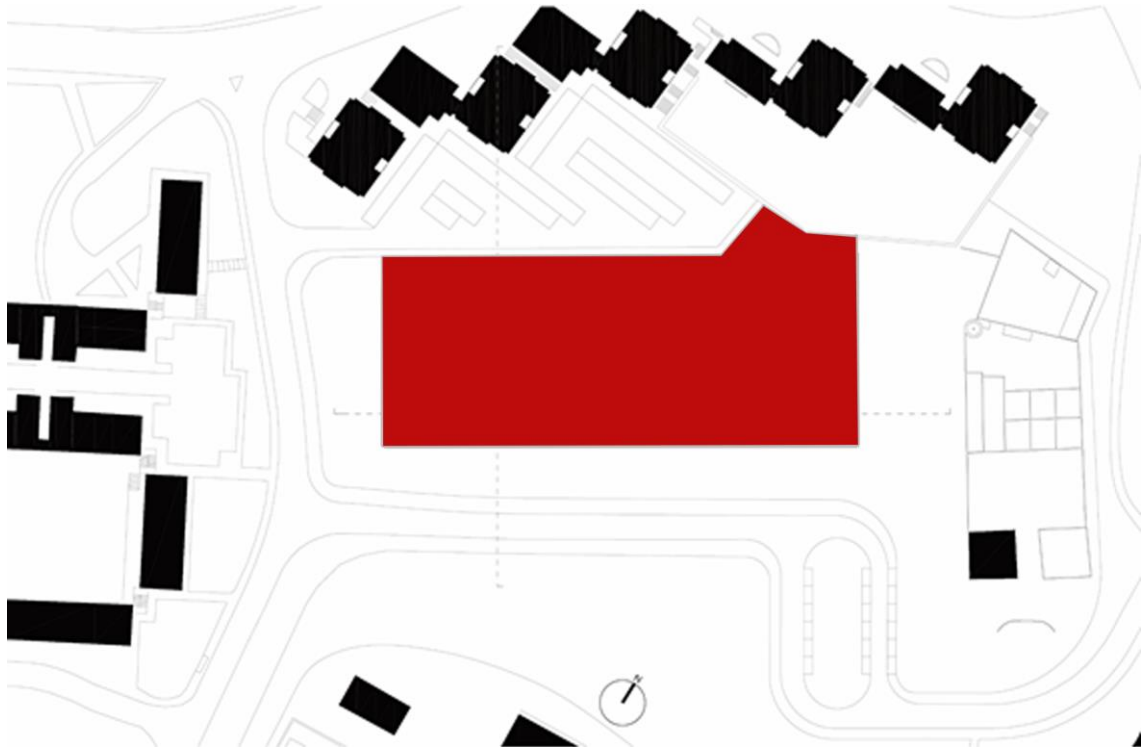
Planta esquemática da plataforma colocada a cota 54.00
